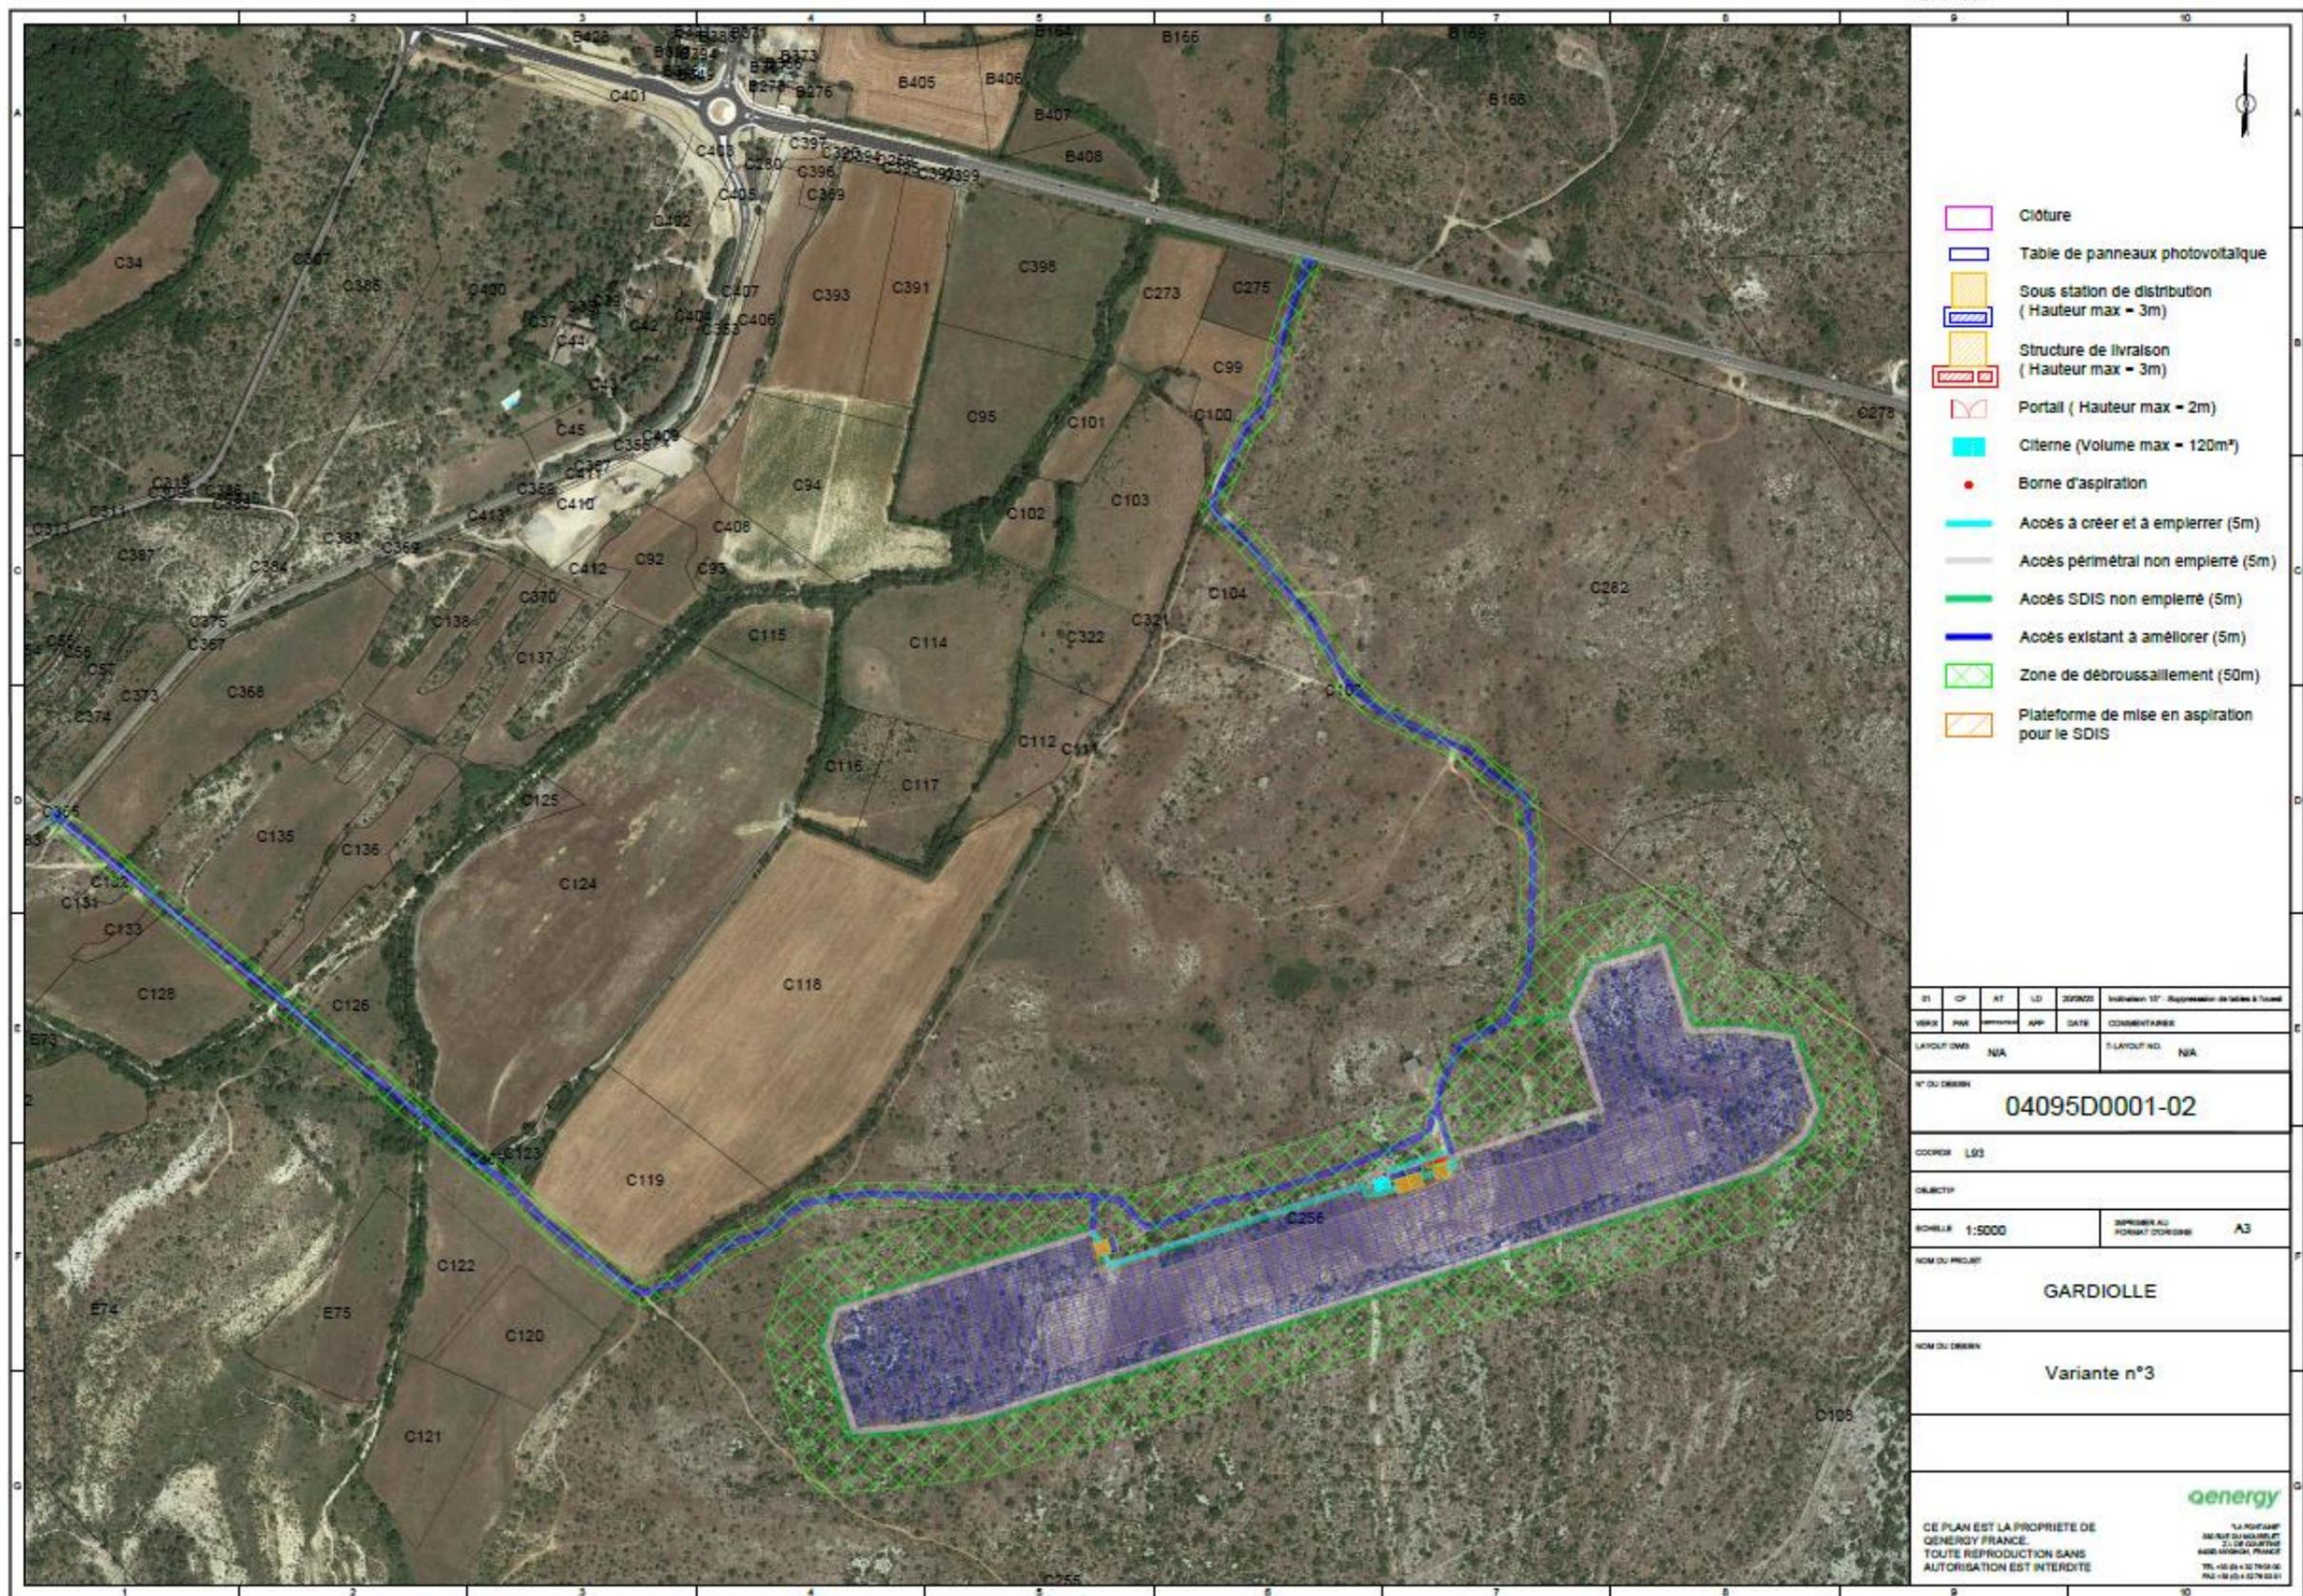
Plan de la variante n°3 du projet « Gardiolle »
